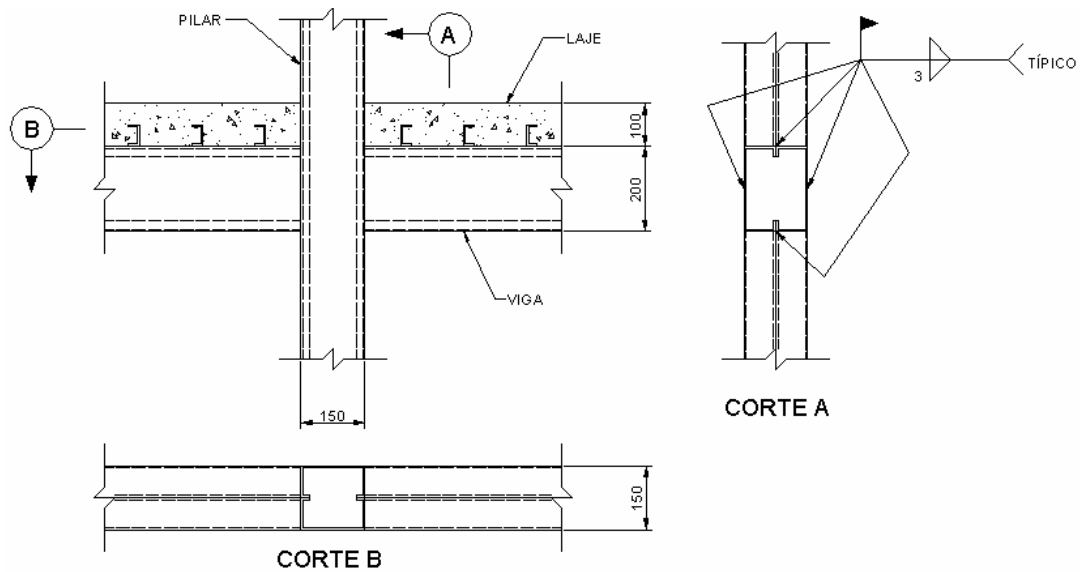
Detalhe construtivo da ligação Viga – Pilar na direcção y [3]
